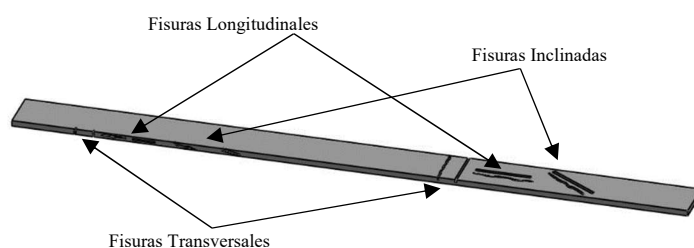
Fisura transversal, longitudinal e inclinada.
